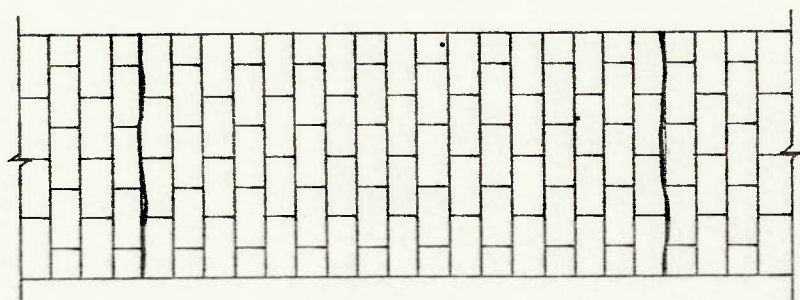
Fissuras regularmente espaçadas em piso externo, devidas a movimentações térmicas do piso
